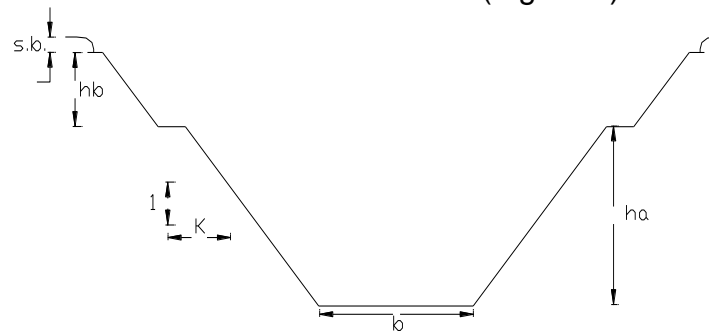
Sección tipo para la sobreelevación del Canal Principal Humaya
